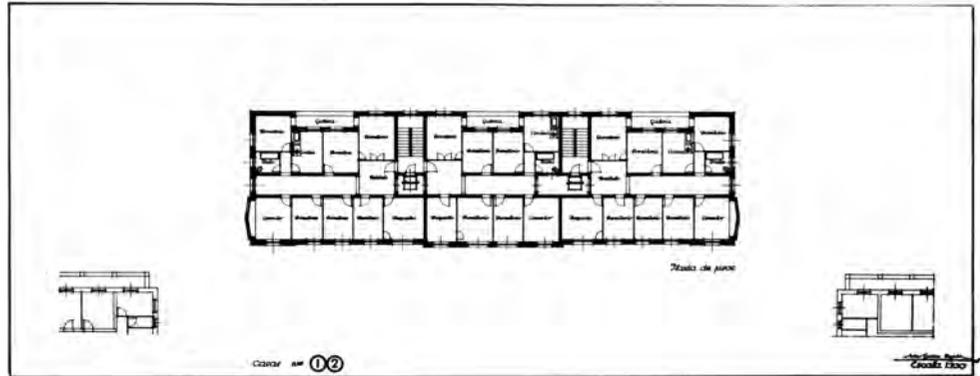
Casa de las Flores, Planta de Pisos y Planta Baja
